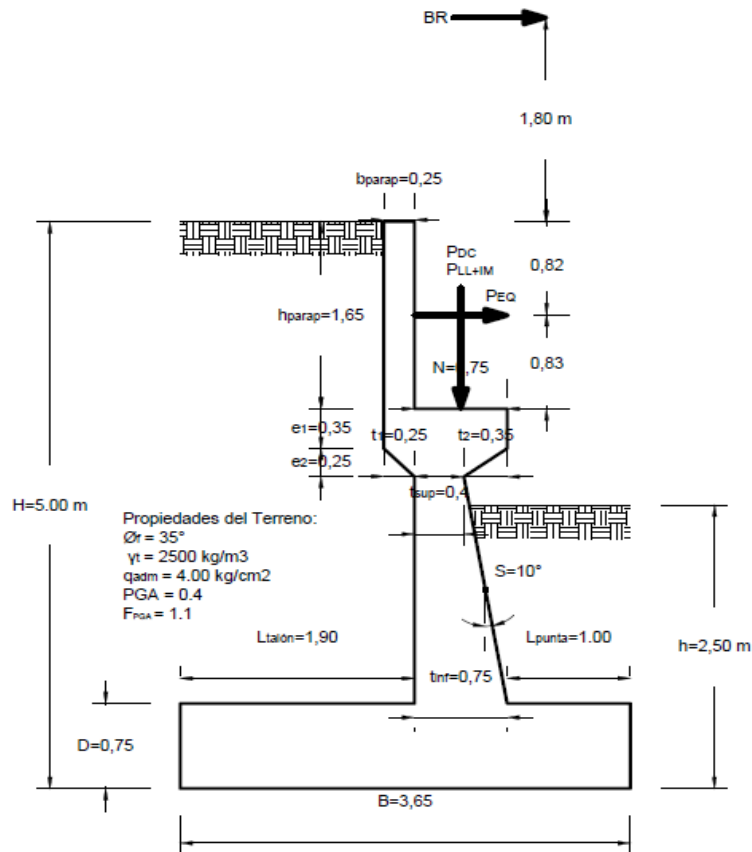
Dimensiones y fuerzas sobre el Estribo
